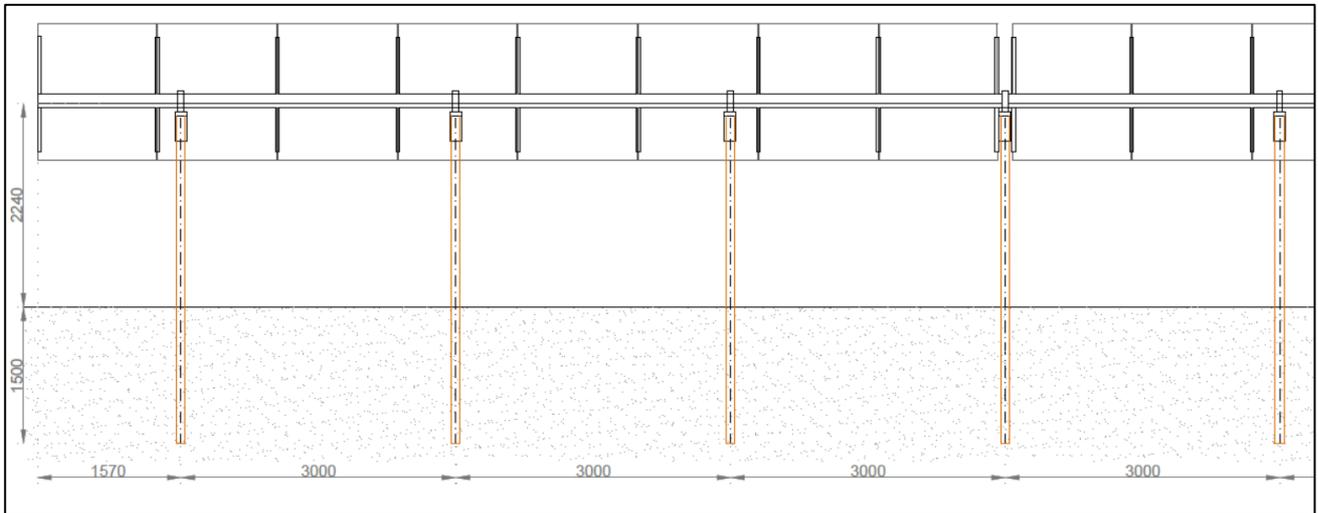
stralcio prospetto struttura di supporto 1x15P-15
